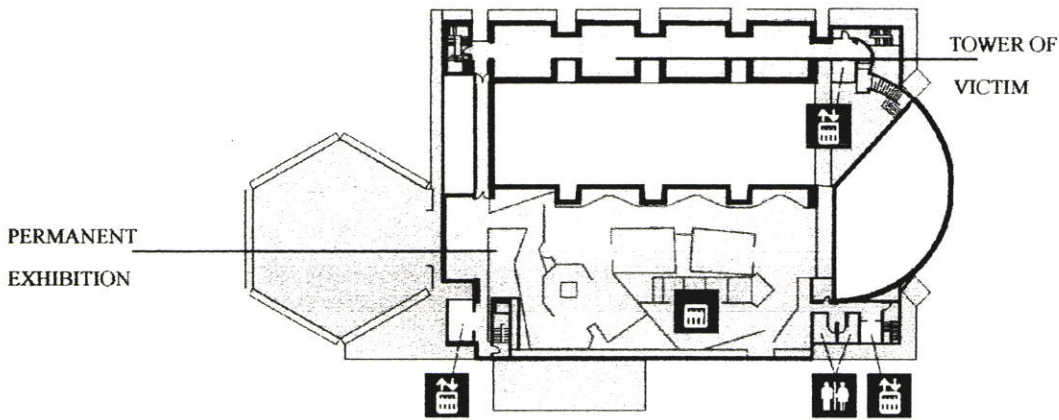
FIRST/MAIN FLOOR PLAN
